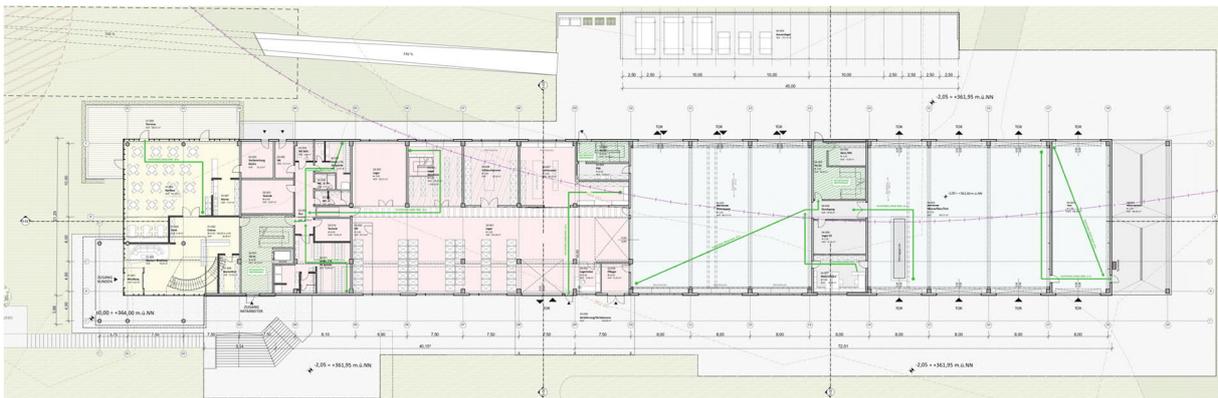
Geplantes Büro- und Hallengebäude, Grundriss Erdgeschoss
